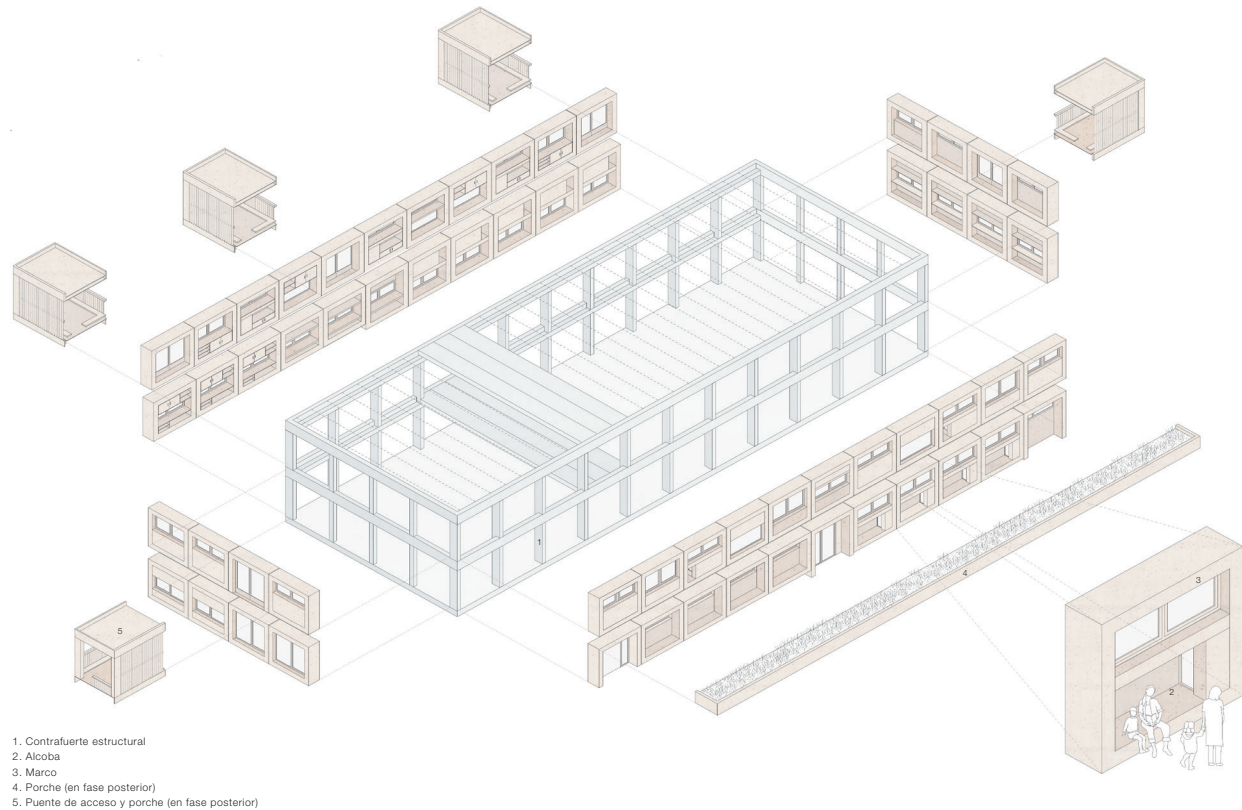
Planimetría y fotografías de la Escuela Til-ler.
